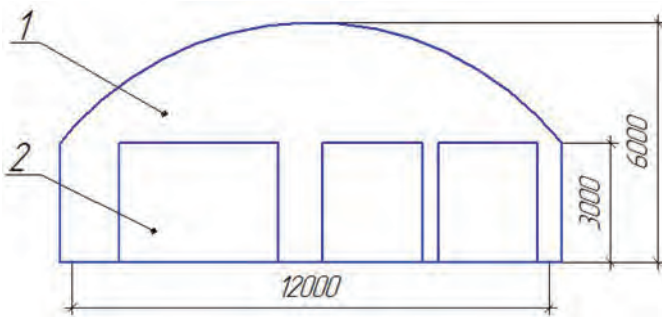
Тваринницька будівля на 25 голів молодняка ВРХ на відгодівлі (фасад)
